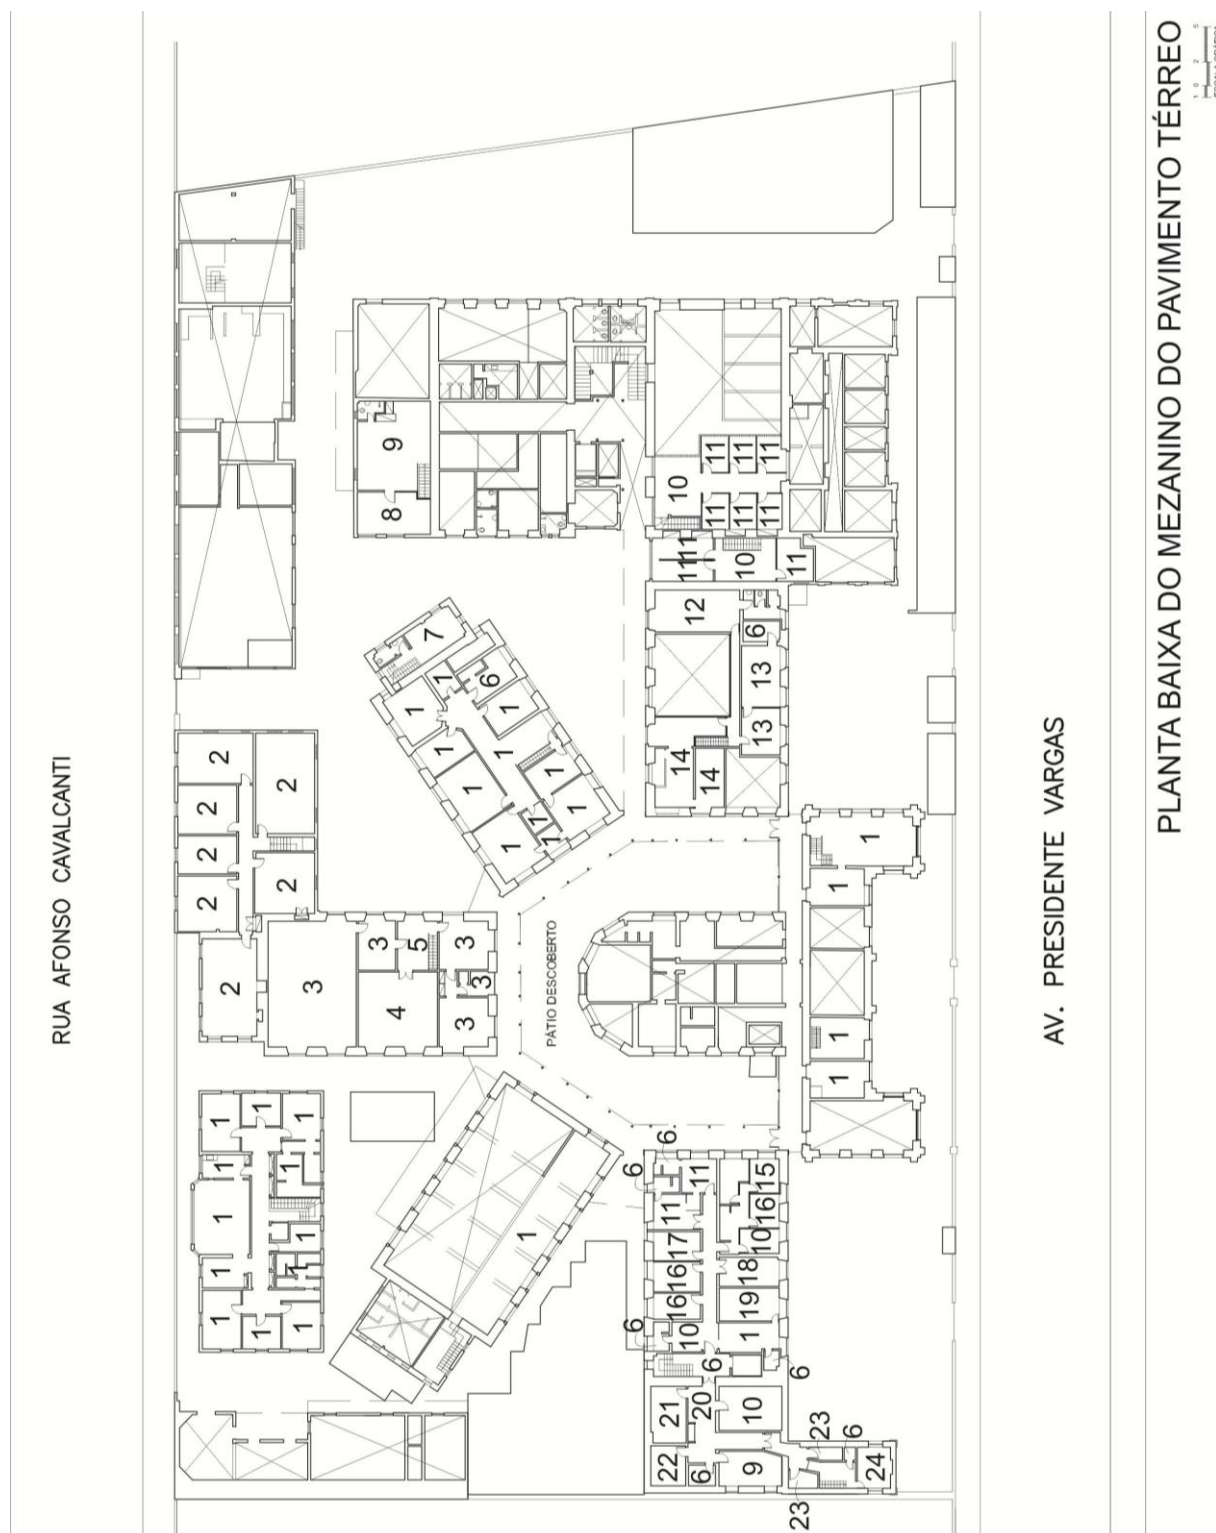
Planta Baixa do Mezanino do Pavimento Térreo – Usos. Fonte: Plano Diretor, 2004.
